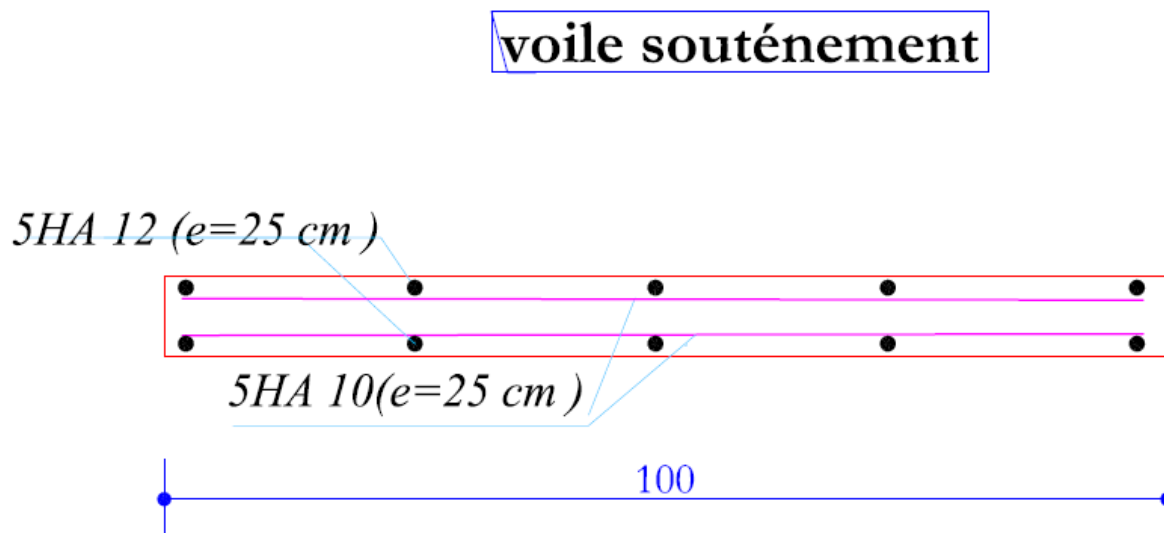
Schéma de ferrailage du mur de soutènement.
